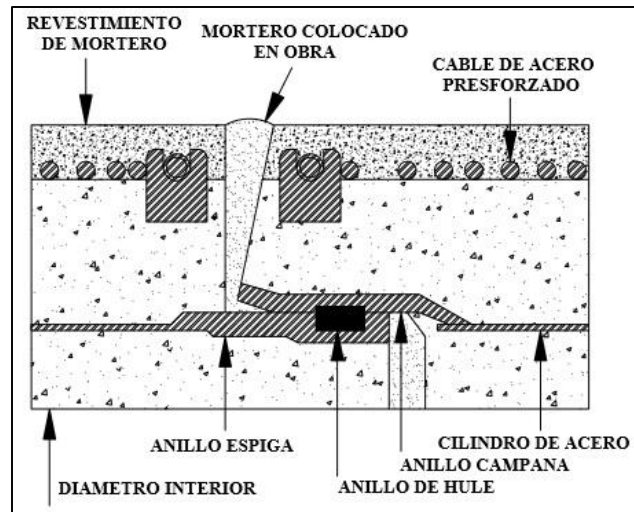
Unión espiga-campana en tuberías de concreto con cilindro de acero.
